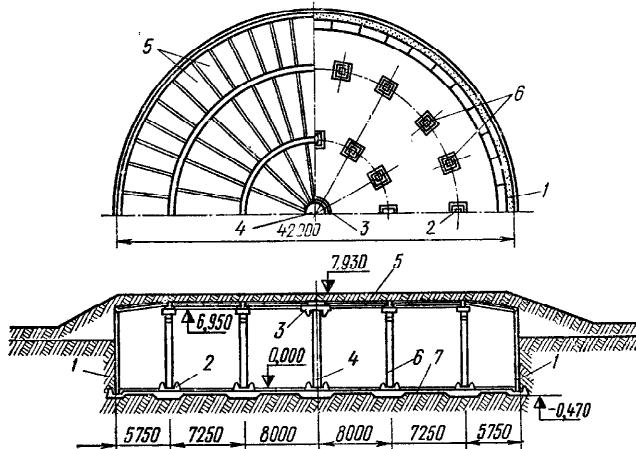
Сборный железобетонный цилиндрический резервуар:
